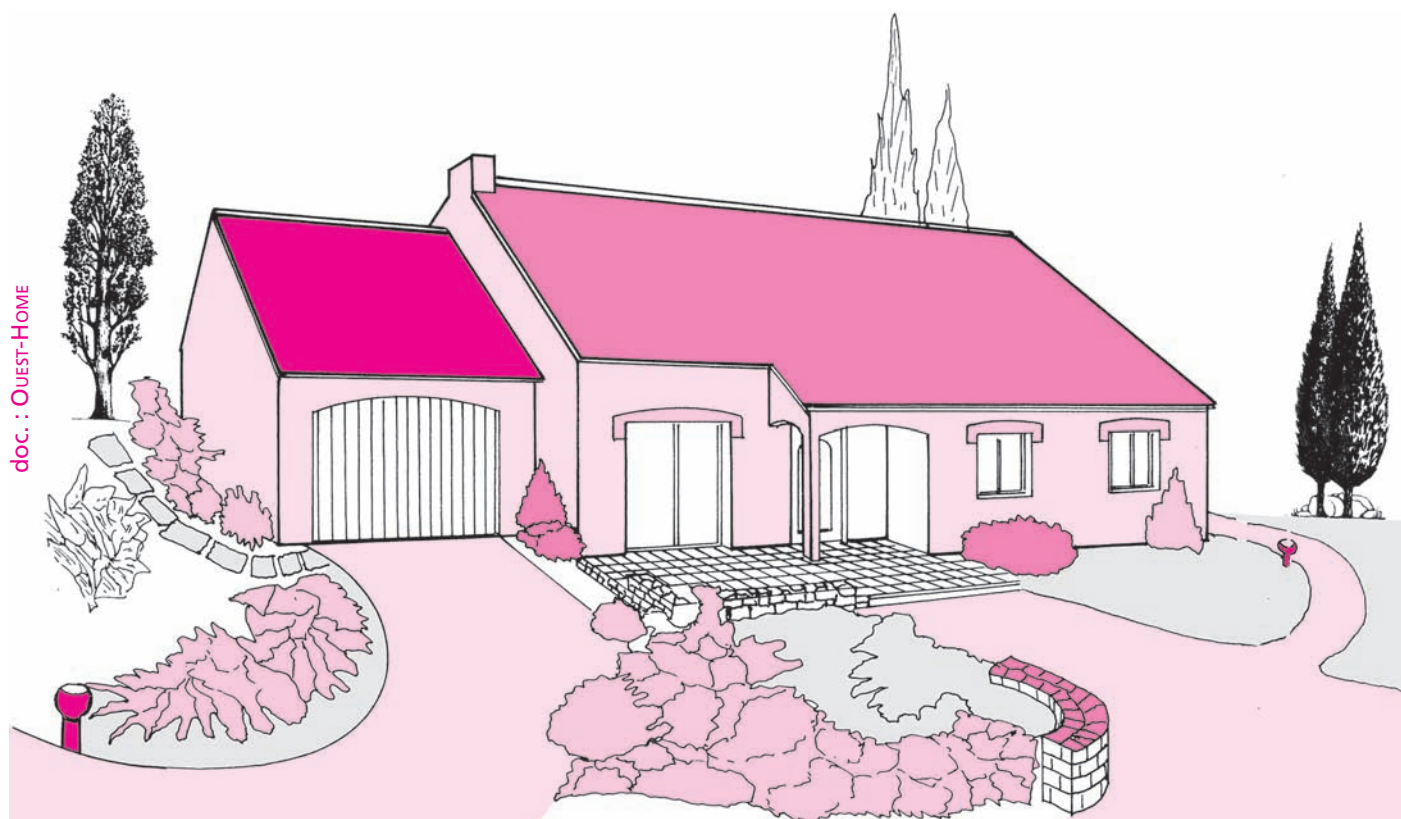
Vue perspective de la maison avec option de choix d'une porte-fenêtre en façade
